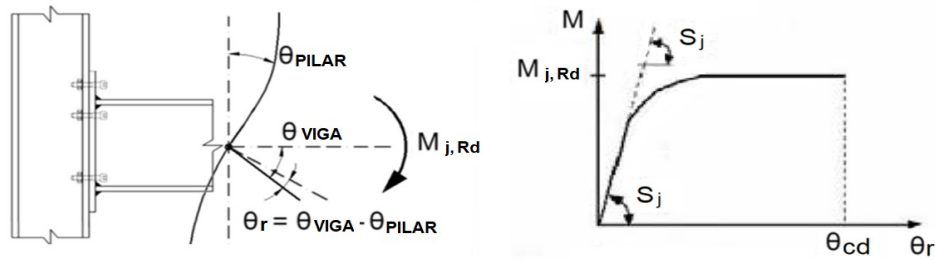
Rotação de uma ligação viga-pilar, adaptado de Silva e Lavall (2009)
